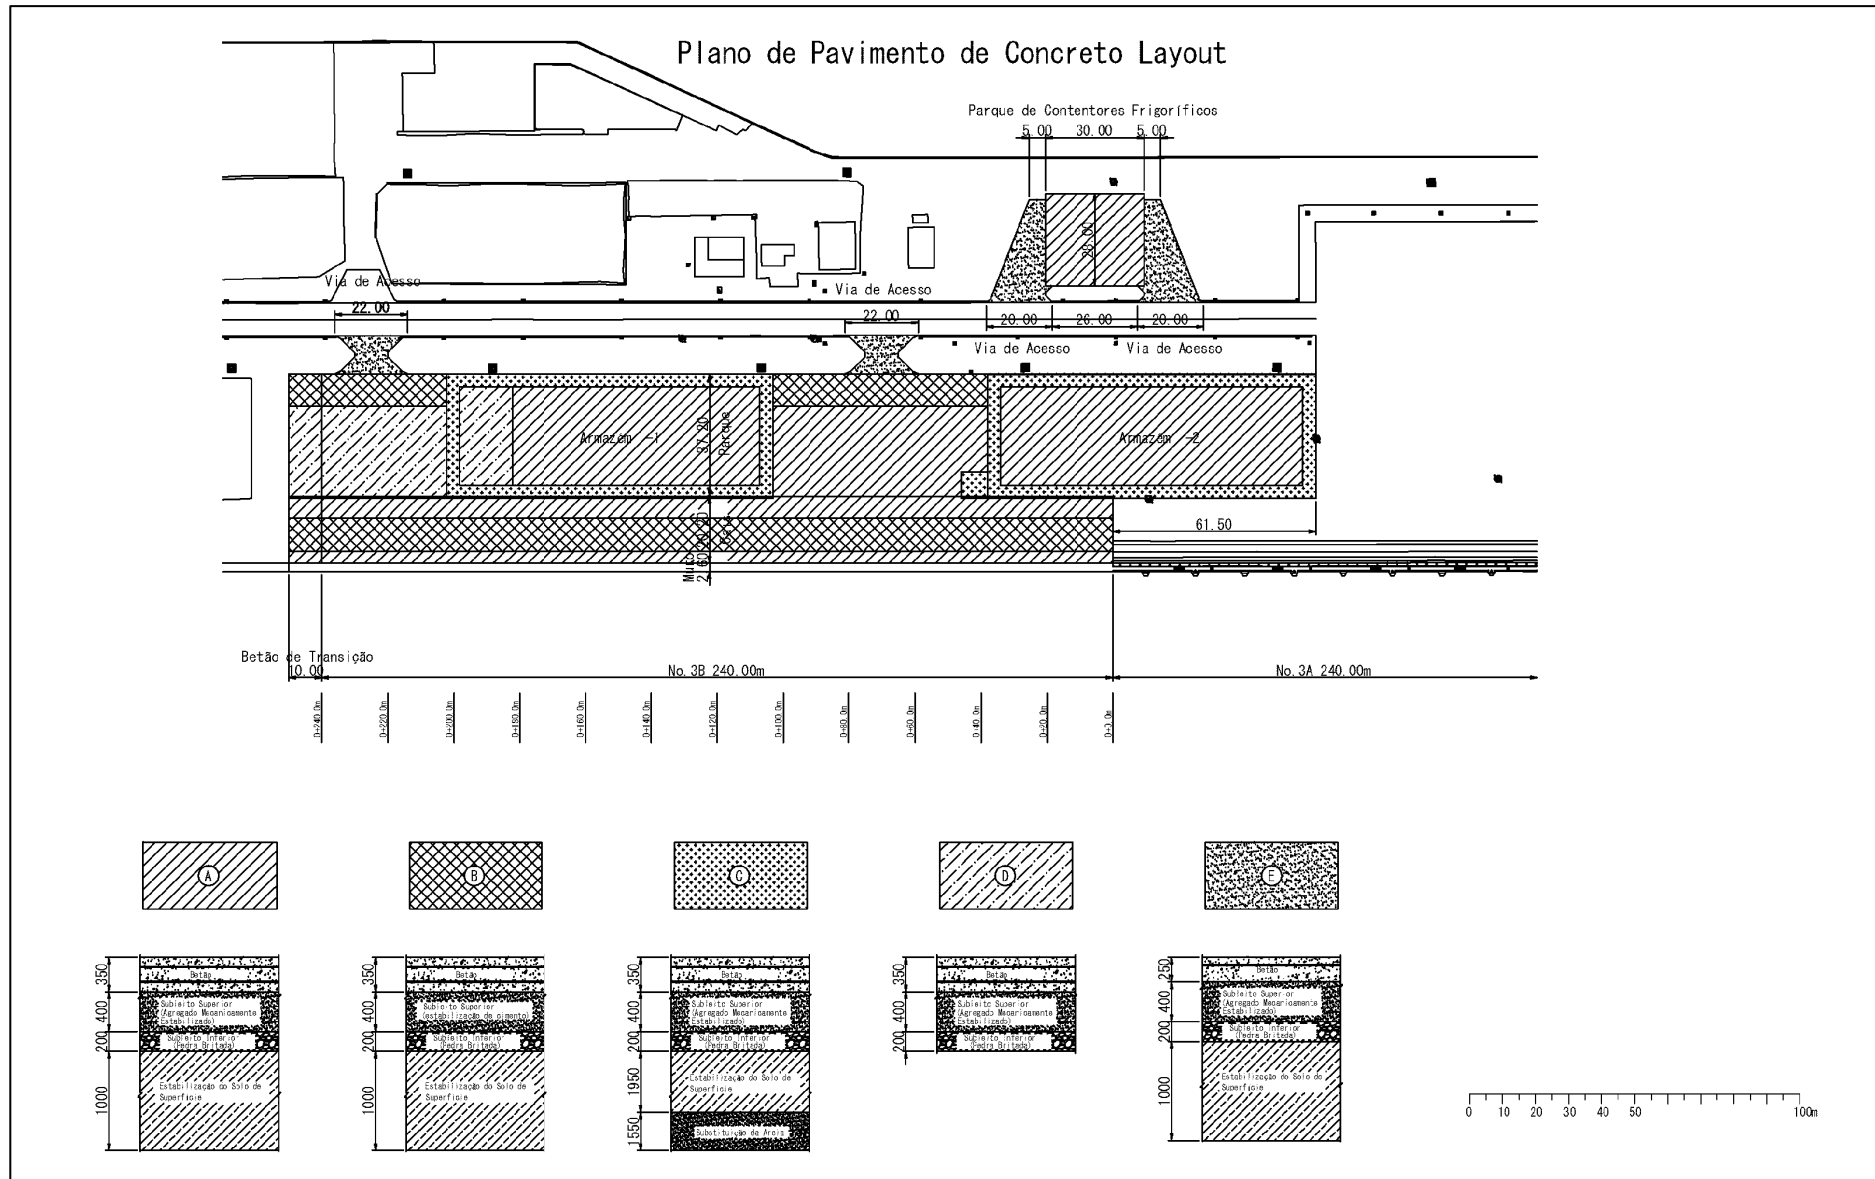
Planta de Faseamento da Pavimentação
